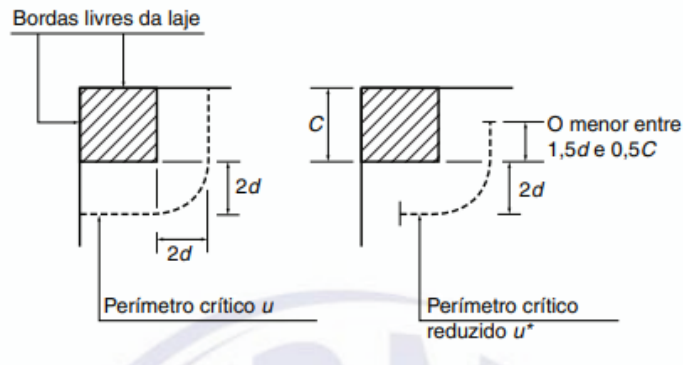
Perímetro crítico na face do pilar de canto (C)
